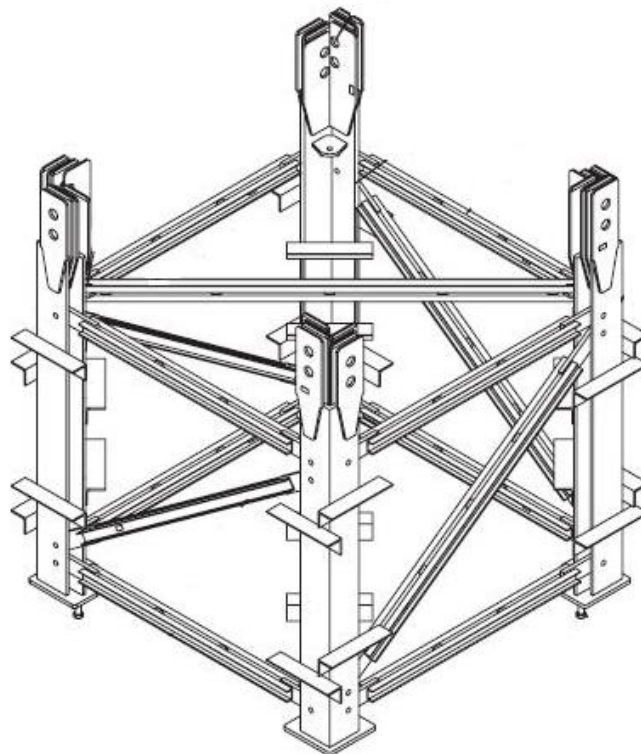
Detalle de tramo de empotramiento que se instala dentro del hormigón.
